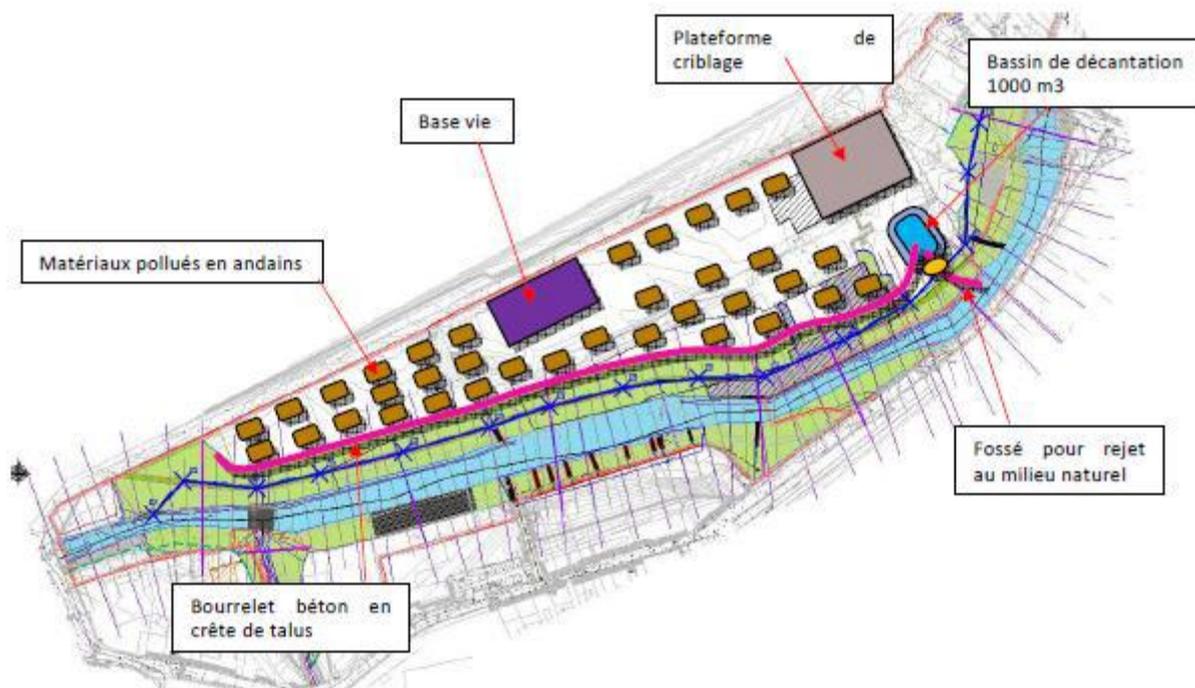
Extrait du plan d'implantation et de gestion de la plateforme de traitement des terres excavées
